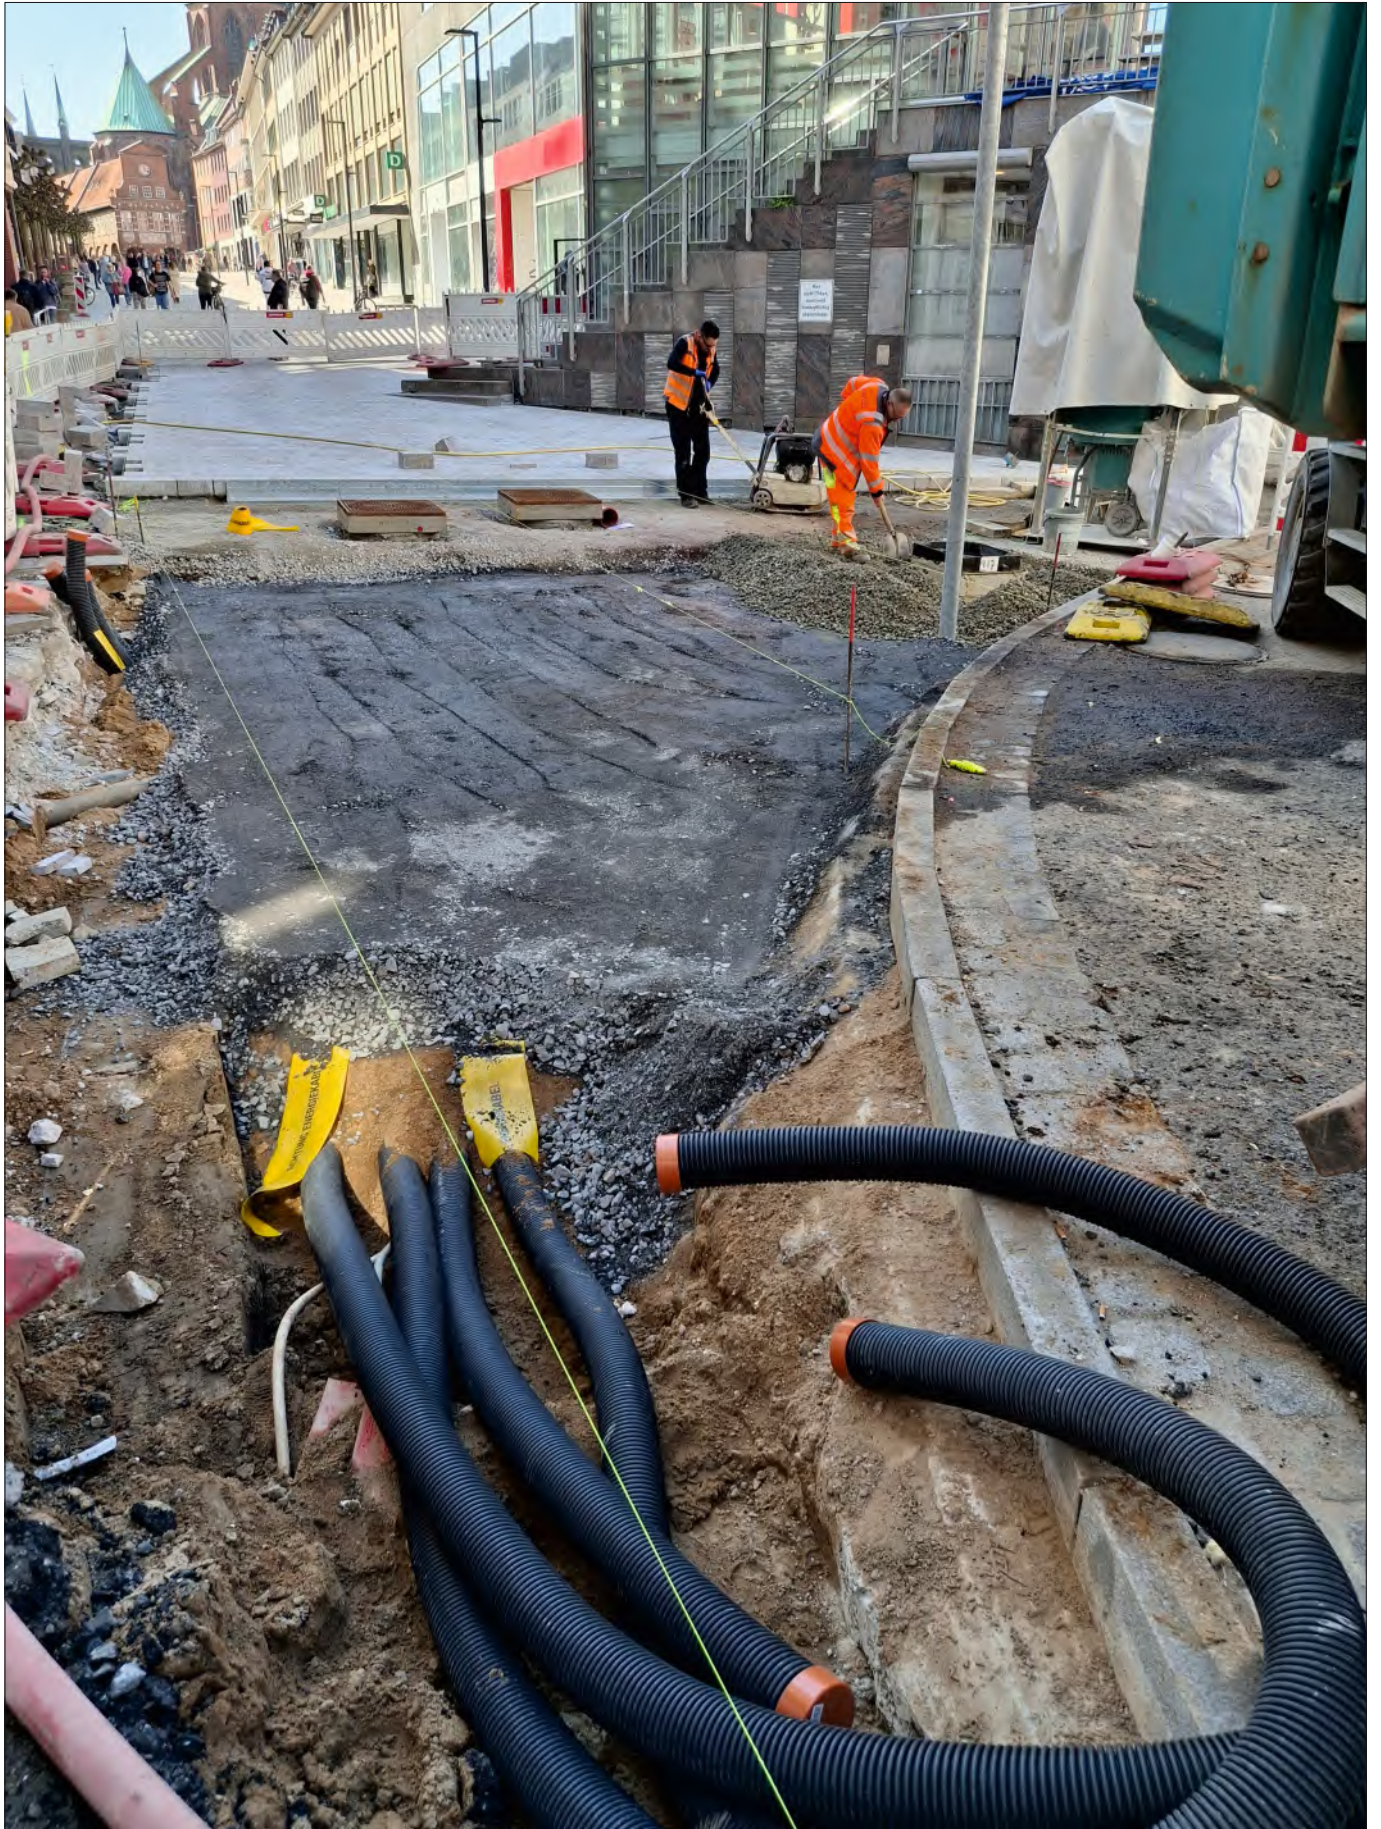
Lübeck, Breite Straße/ Beckergrube, neuer Straßenaufbau während der Baumaßnahme – HL/Abt. Denkmalpflege/Klopp/2024.
